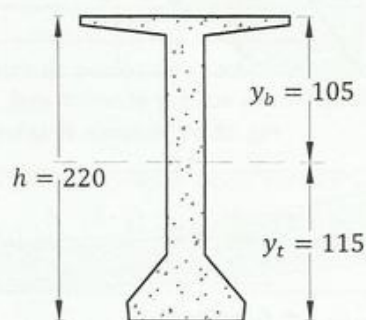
Sección transversal de la viga del Ejemplo 15.5
